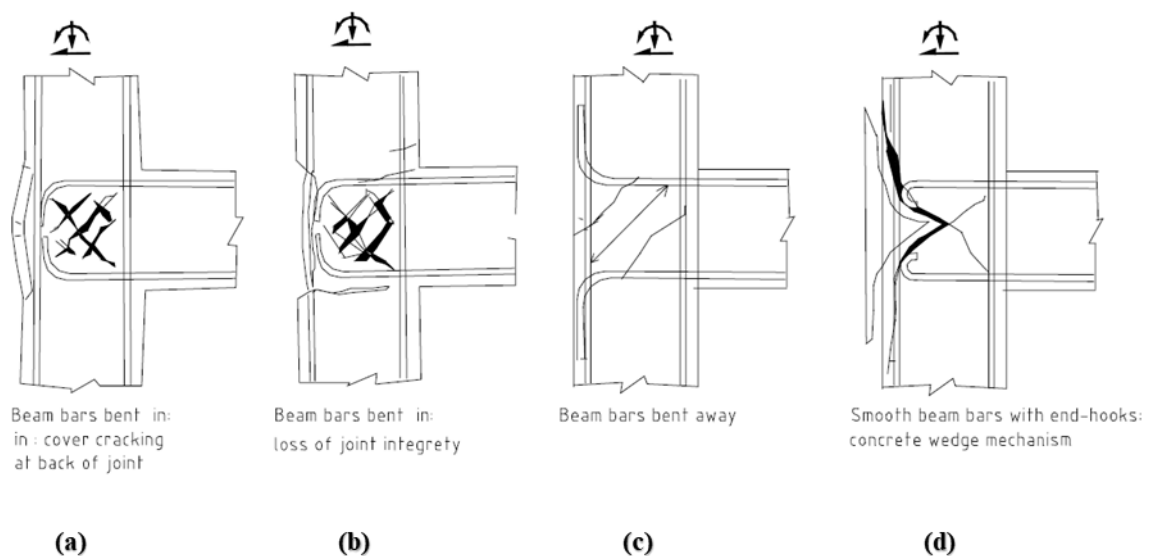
Alternativa de mecanismo de daño para un nudo con forma de T: a,b) viga con barras dobladas en la región de unión; c) viga con barras dobladas fuera de la región de unión; d) vigas con barras lisas con ganchos finales [2]
